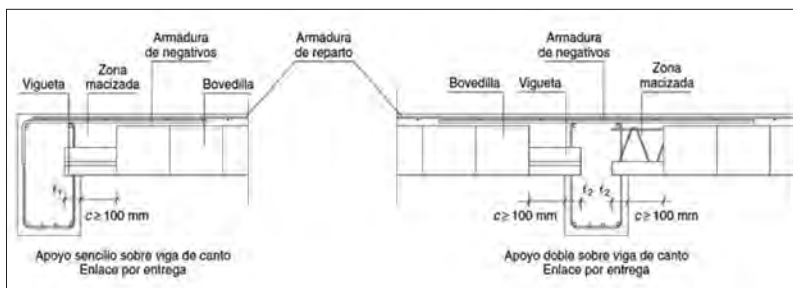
y 14: apoyo sobre viga de canto. Enlace por entrega.
